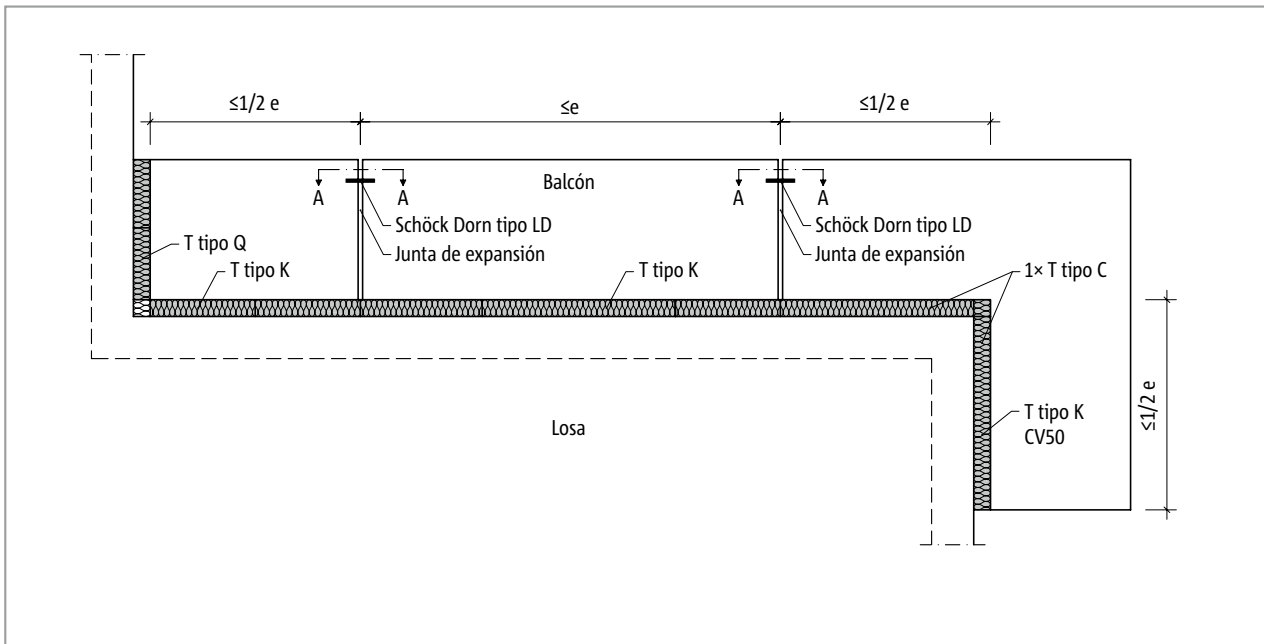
Schöck Isokorb® T tipo K: Formación de juntas de expansión con espiga de fuerza transversal desplazable longitudinalmente, p. ej., Schöck Dorn
